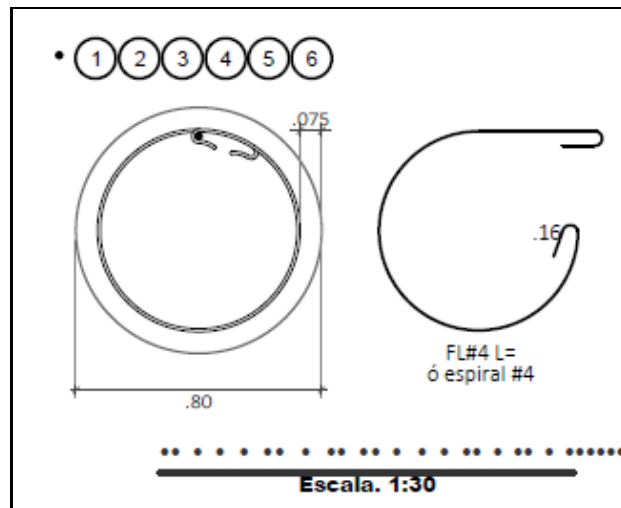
Detalle de Refuerzo Vertical Elemento Pilote 24-C1.
